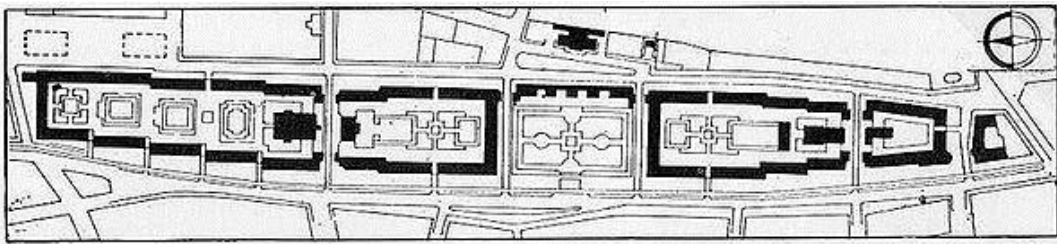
Planta del Proyecto, Fuente: www.Urbipedia.com
